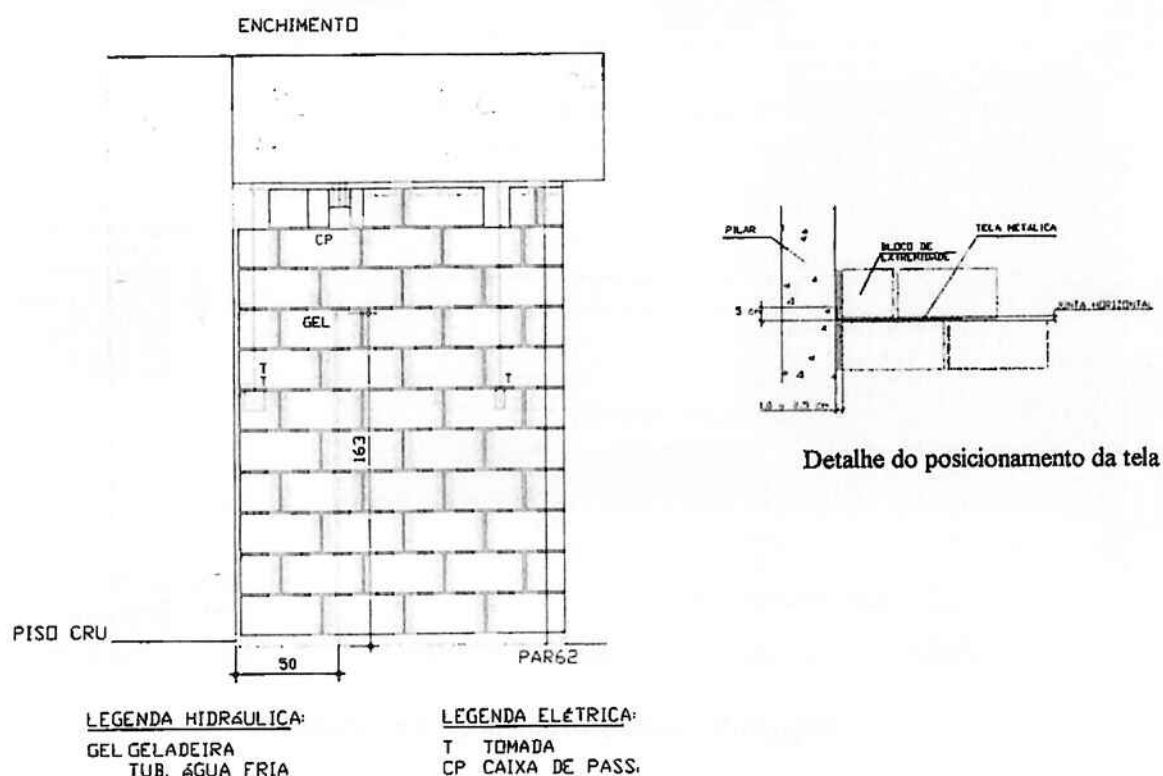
Fixação da alvenaria na estrutura com tela metálica
